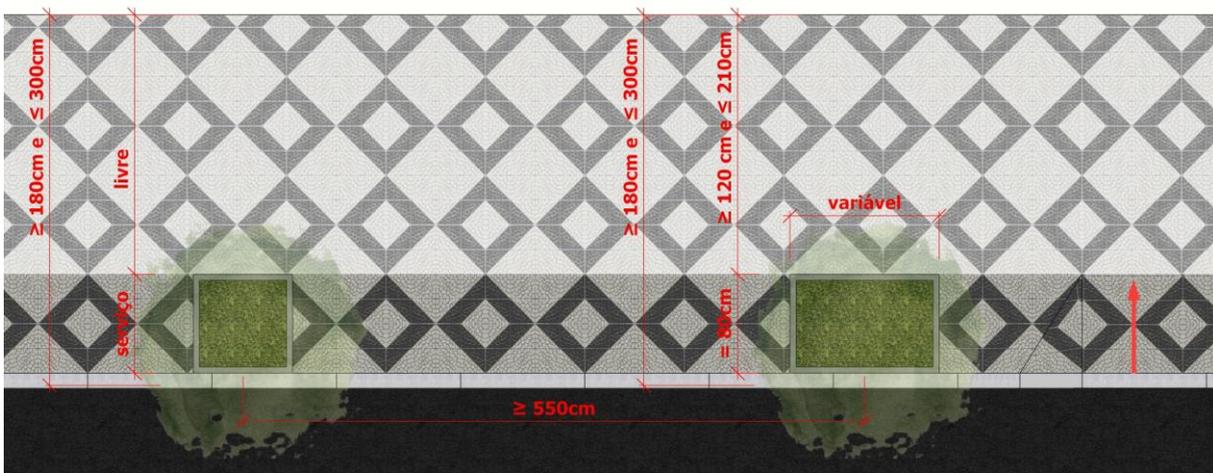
Dimensões Faixas Calçadas até 180 cm em Planta Baixa
